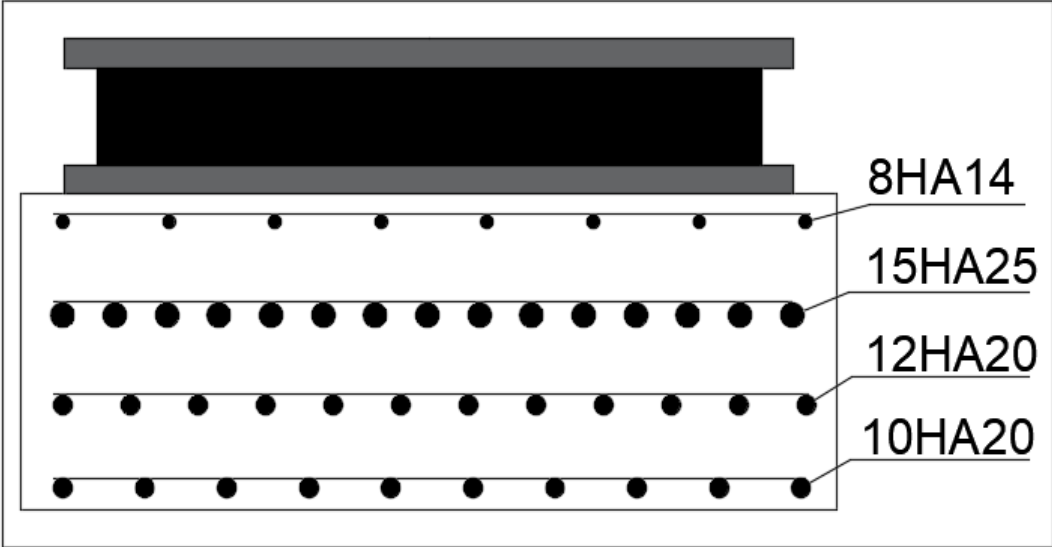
Ferrailage du dé d'appui au niveau de la pile.
